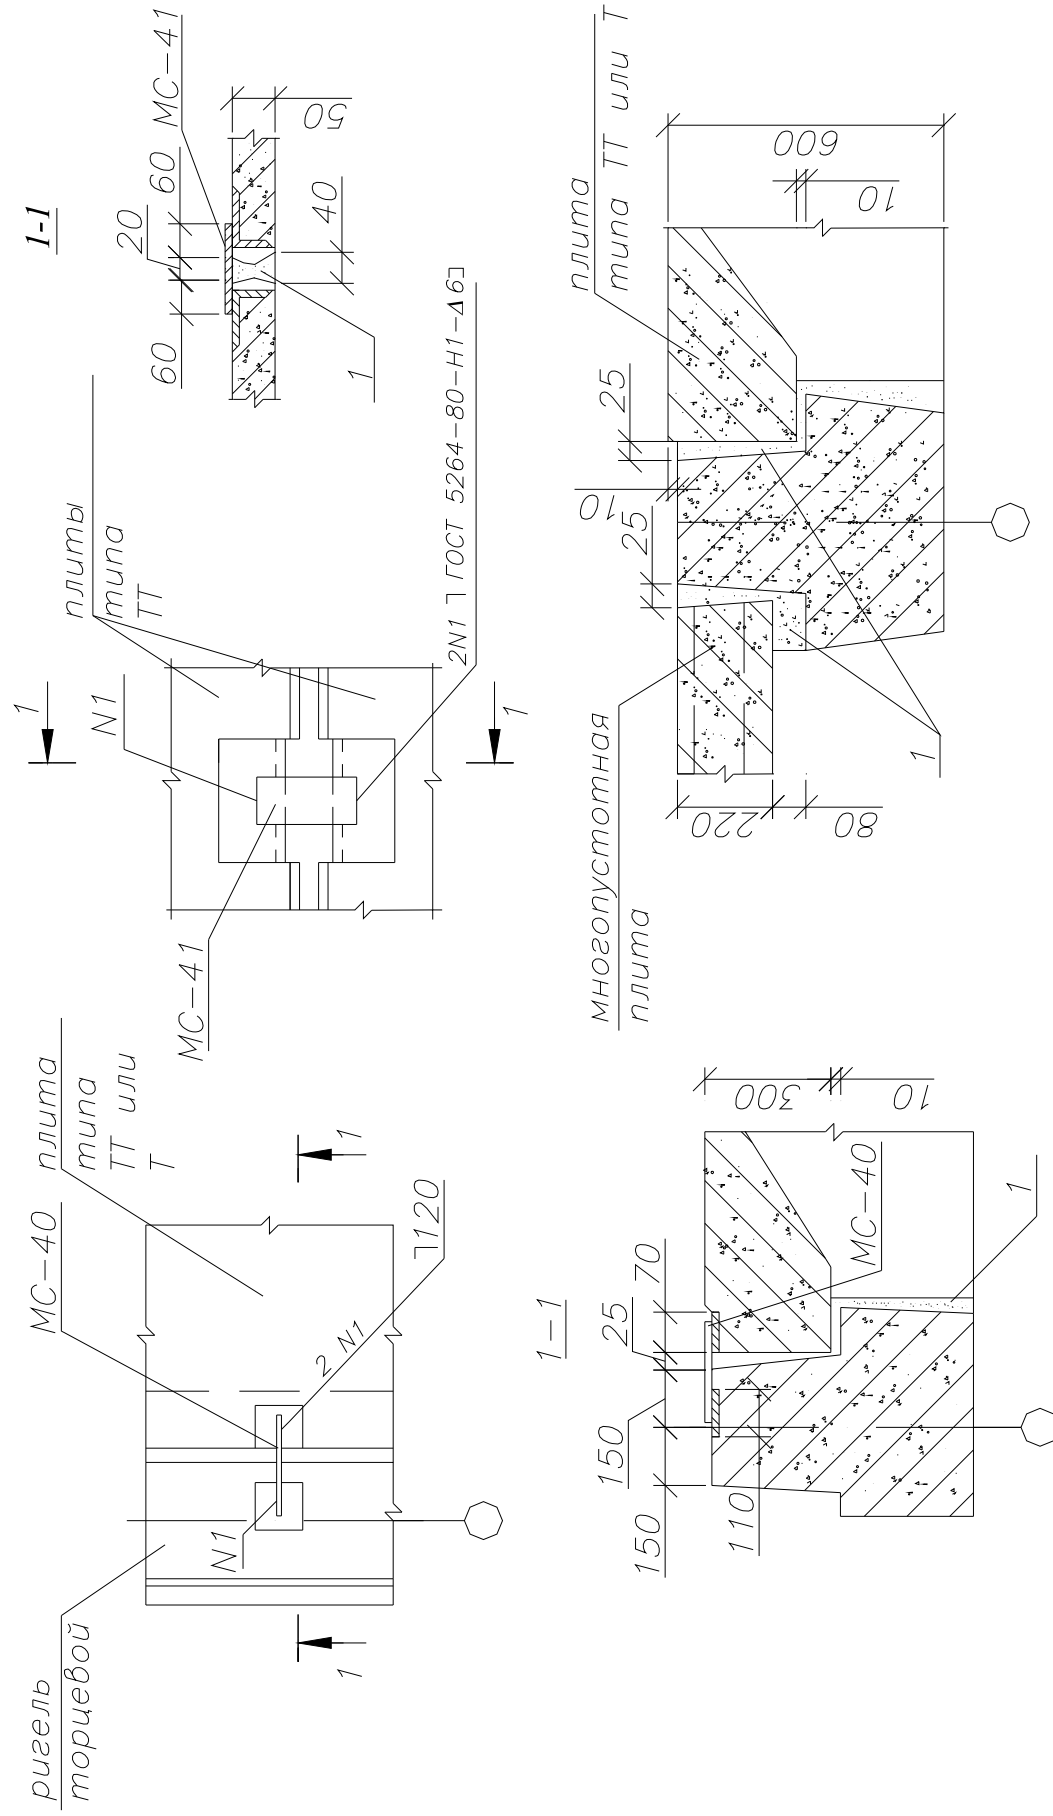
Опираие и крепление плит покрытия сечением Т-2Т
